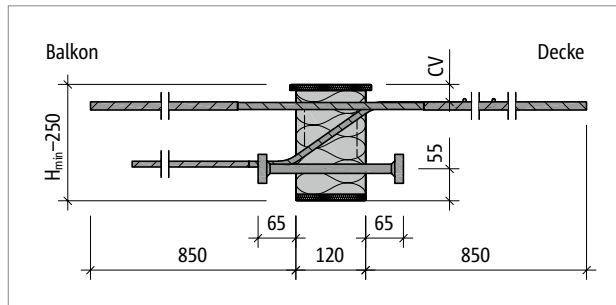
Schöck Isokorb® XT Typ KP-M11: Produktschnitt
